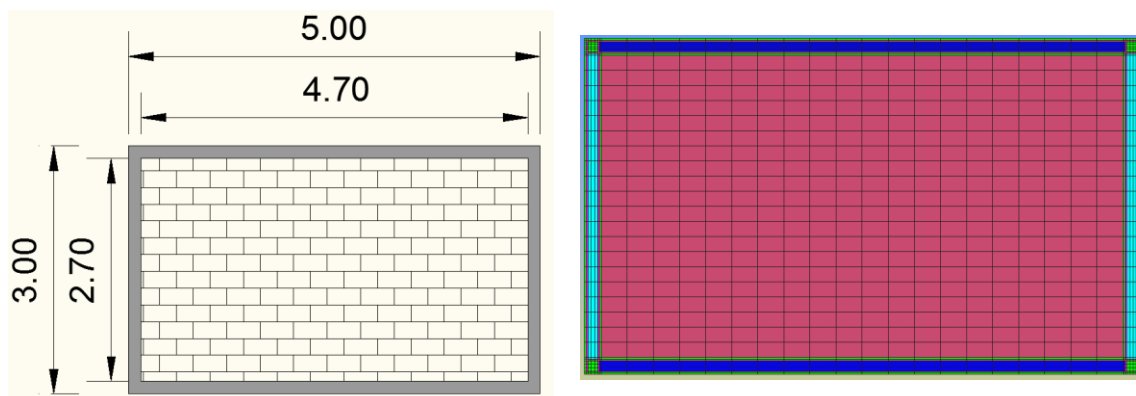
Mallas de elementos finitos para el muro encadenado
